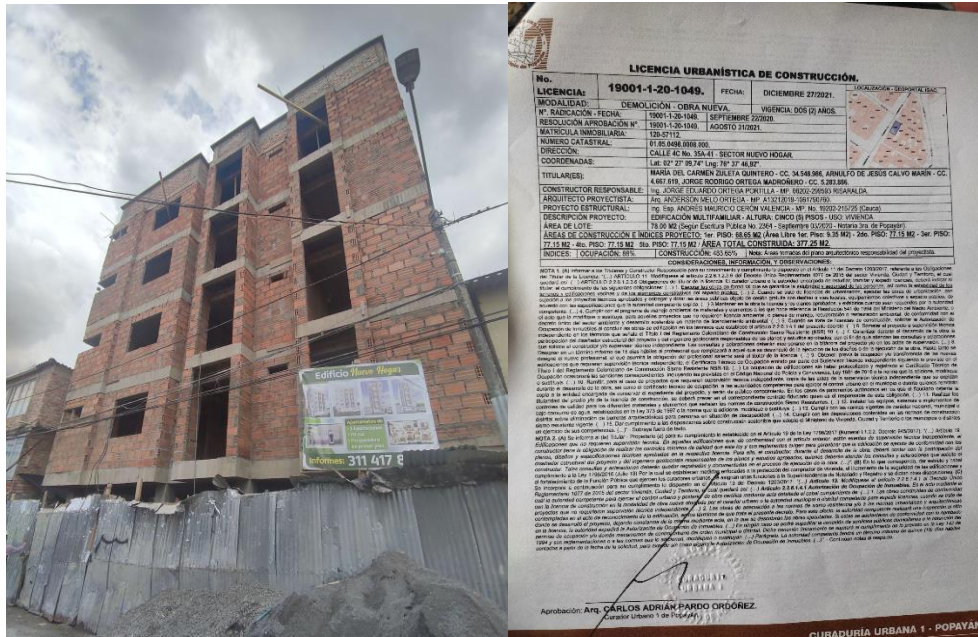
Fachada – Licencia de construcción Curaduría Urbana 1
